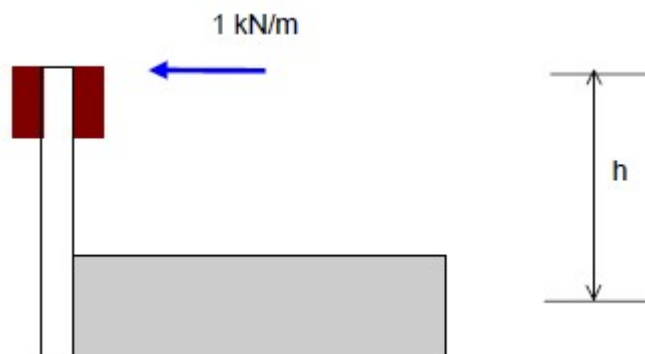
Força no guarda-corpo (Fonte: Manual de projeto e construção de pontes de madeira – LaMEM)
